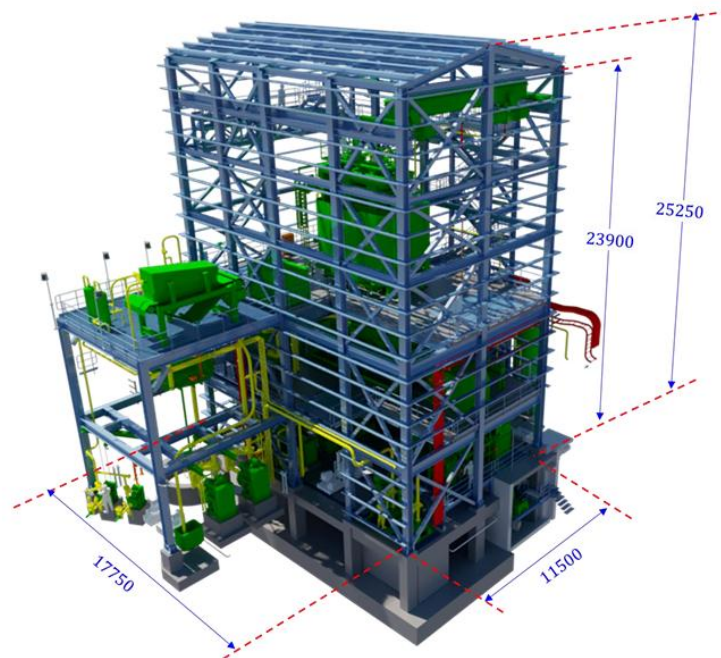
Vista 3D edificio filtro Larox (Dimensiones en mm)
